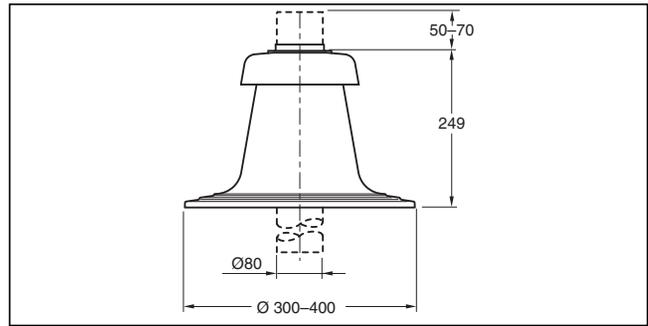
Schachtabdeckung für 80 mm (Maße in mm)
